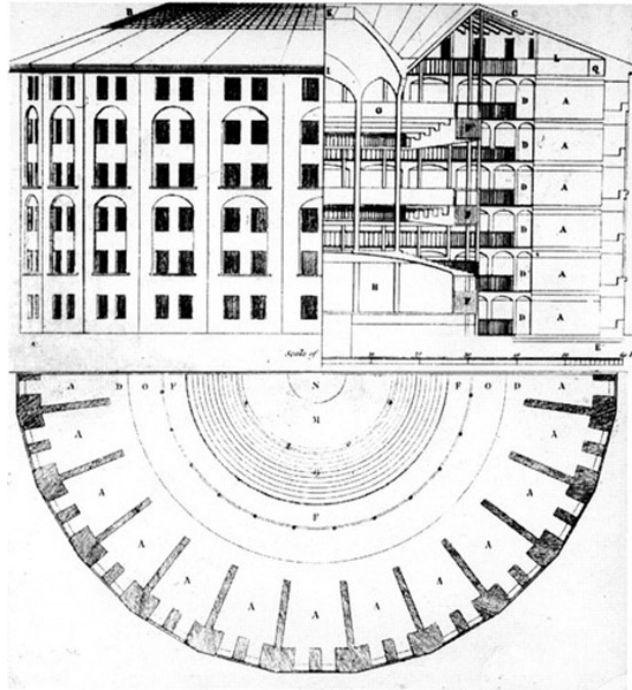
Panóptico de Bentham (fachada, corte e planta baixa)
